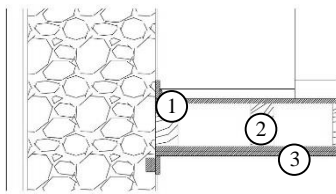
Pormenor construtivo dos pavimentos interiores (Ramos, 2009).
